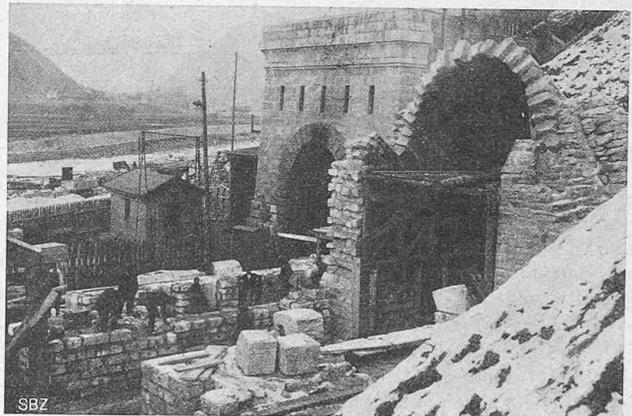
Portal II im Bau, rechts „Pfeife“ zu Tunnel II.
